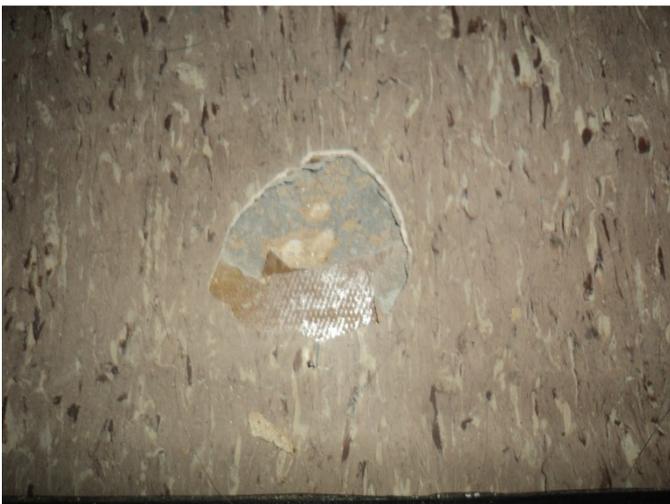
Baumstr. 8 Flur EG (Kunststoff P 24)
